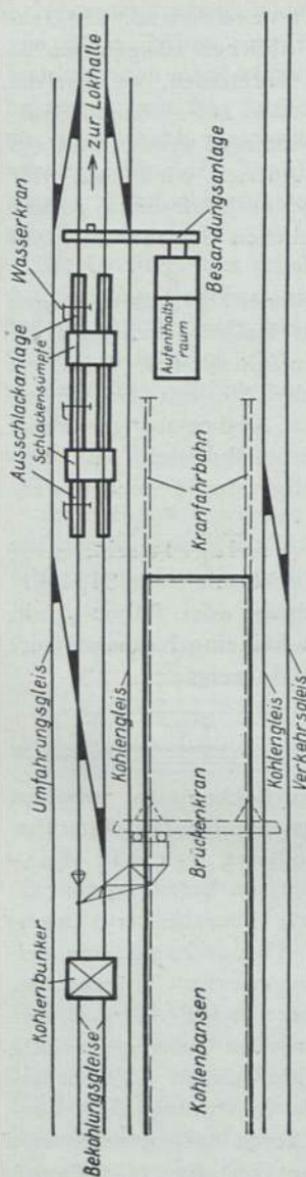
Lageplan einer Bekohlungs- und Ausschlackanlage
